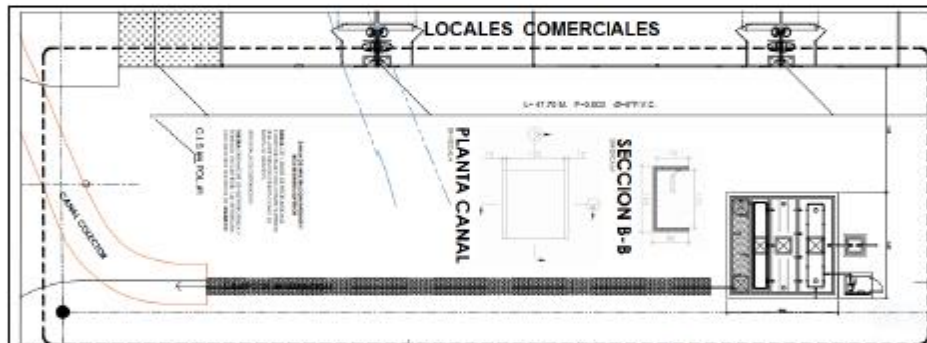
Vista en planta para la implementación de la Zanja de Infiltración y Biojardin/Humedal
